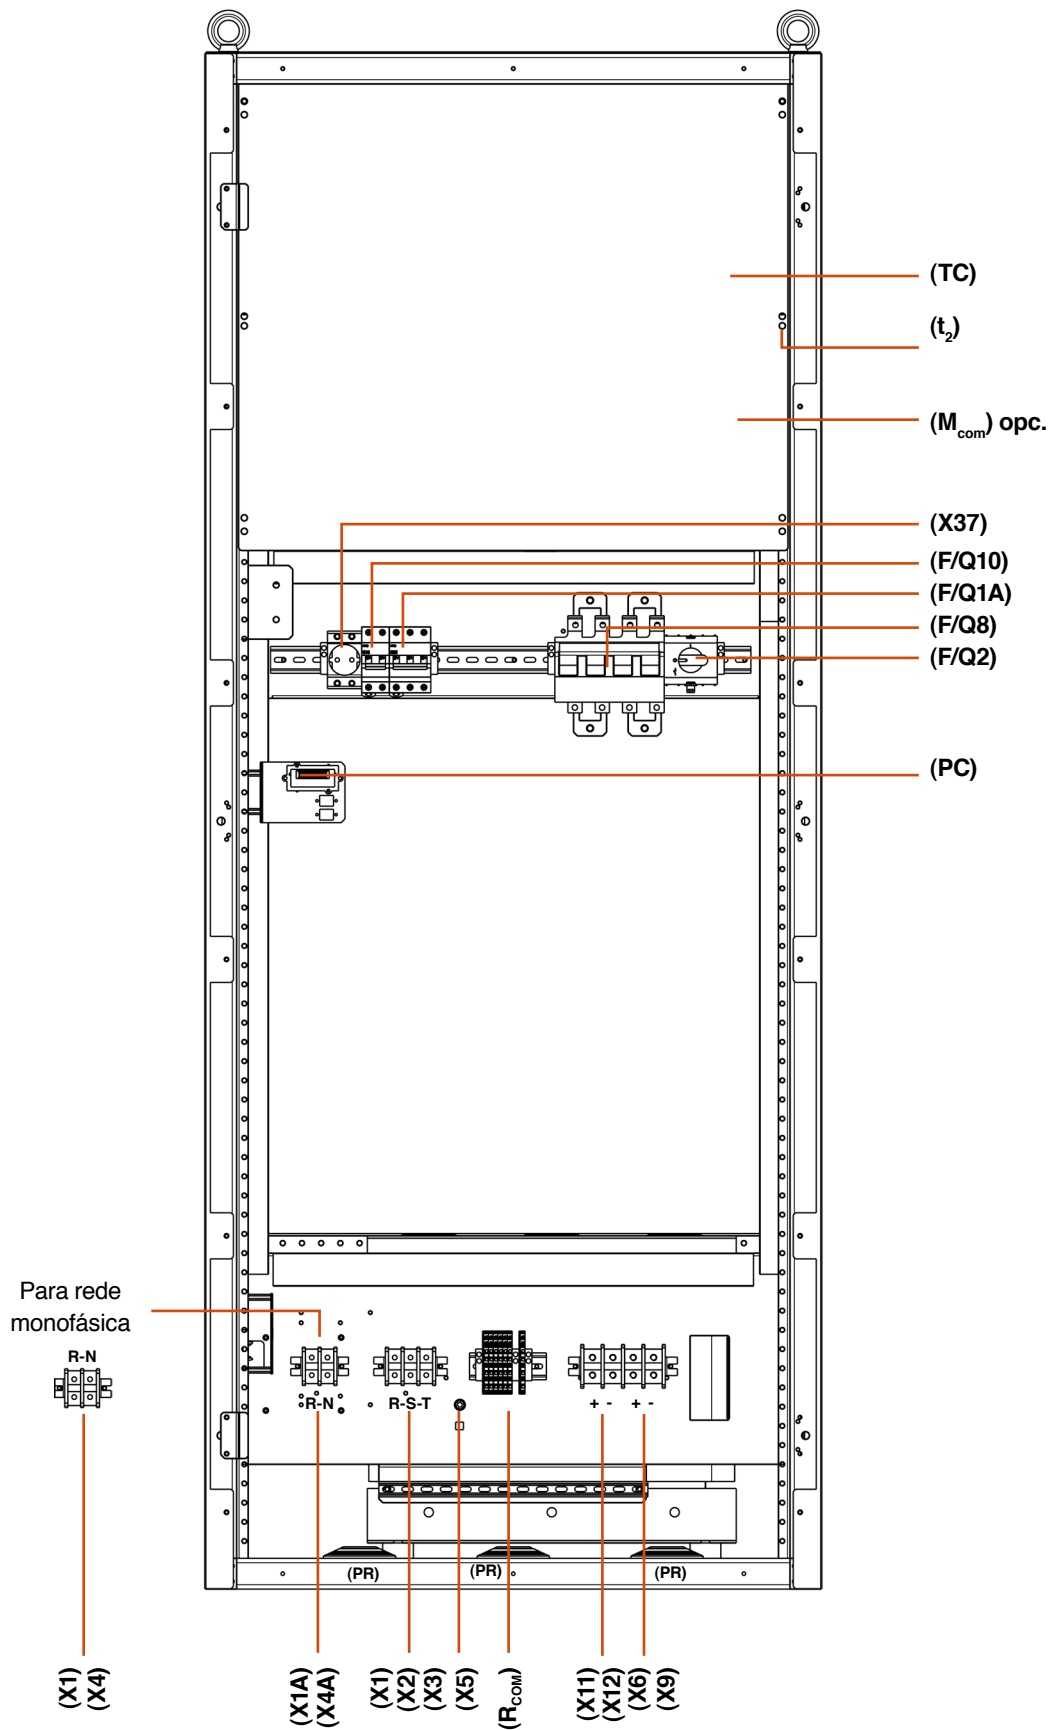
Vista frontal do armário de equipamento de 630 mm x 805 mm x 2115 mm sem porta (PF) e com a tampa de terminais (TB) retirada.
